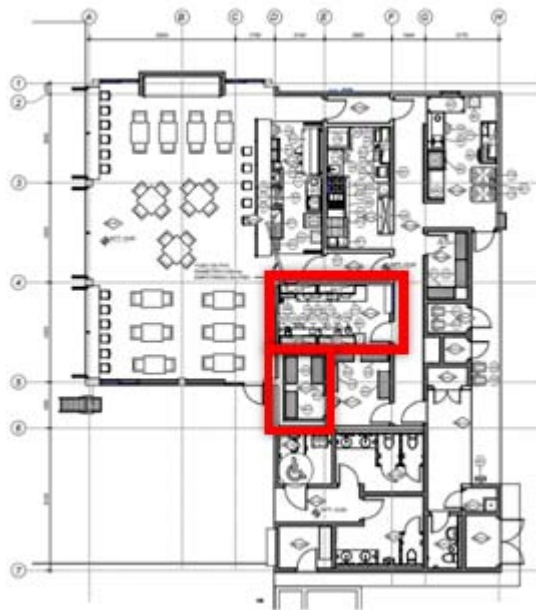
Planta arquitectónica nivel +0.00 m - Edificio 02
